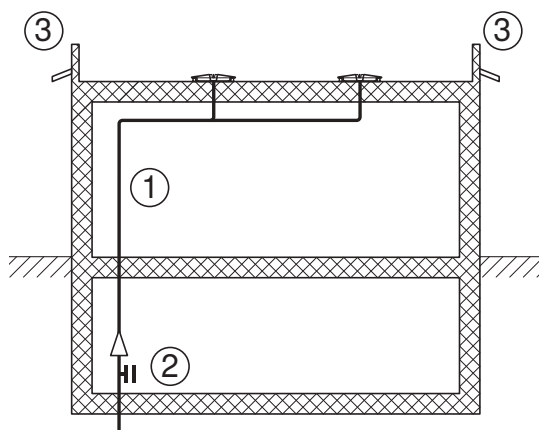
Naissance d'eaux pluviales et tracé de conduite sur toitures plates avec parapet
